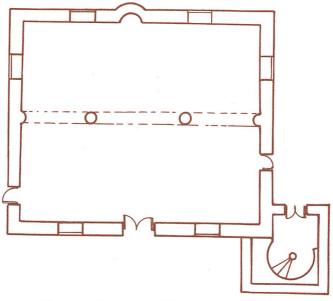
المسقط الأفقى لغرفة سبيل مسجد أبو مندور برشيد مقياس رسم 1:.0
